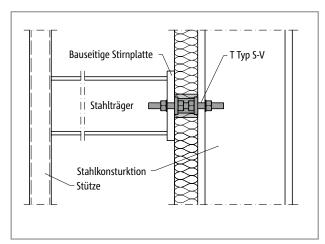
Schöck Isokorb® T Typ S-V: Stahlkonstruktion gestützt
